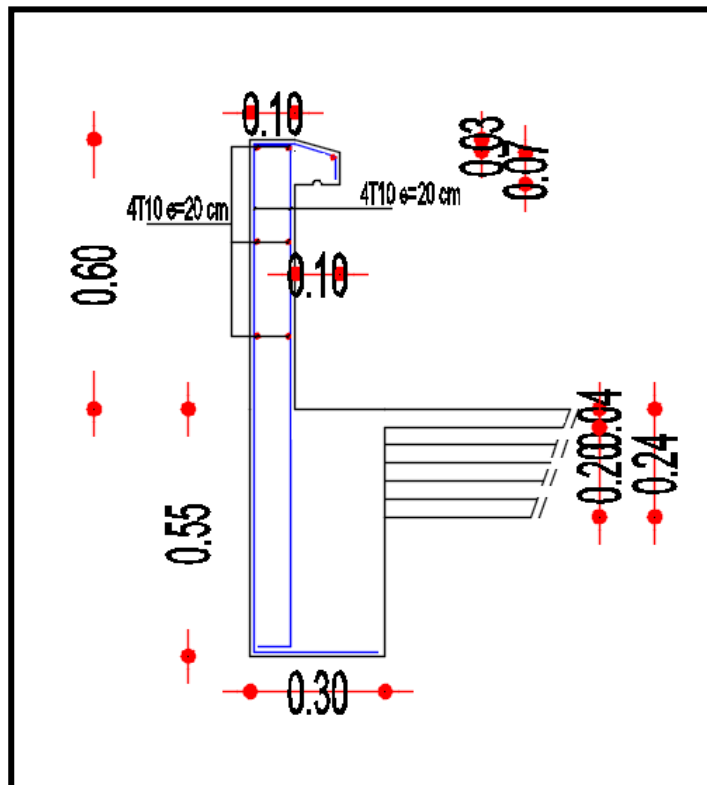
schéma de ferrailage de l'acrotère (Terrasse inaccessible)
